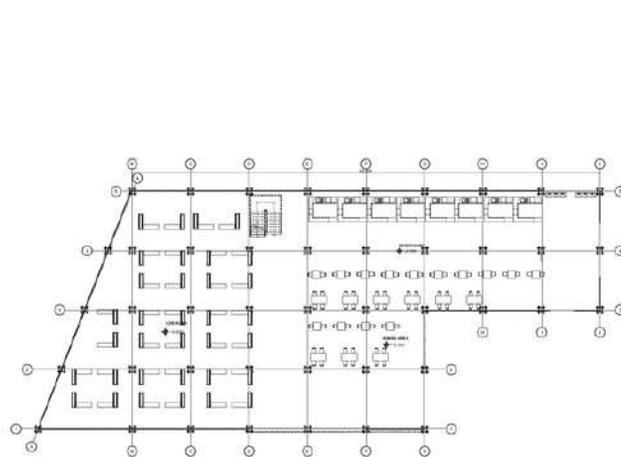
Skematik Denah Bangunan Utama Lt 1
